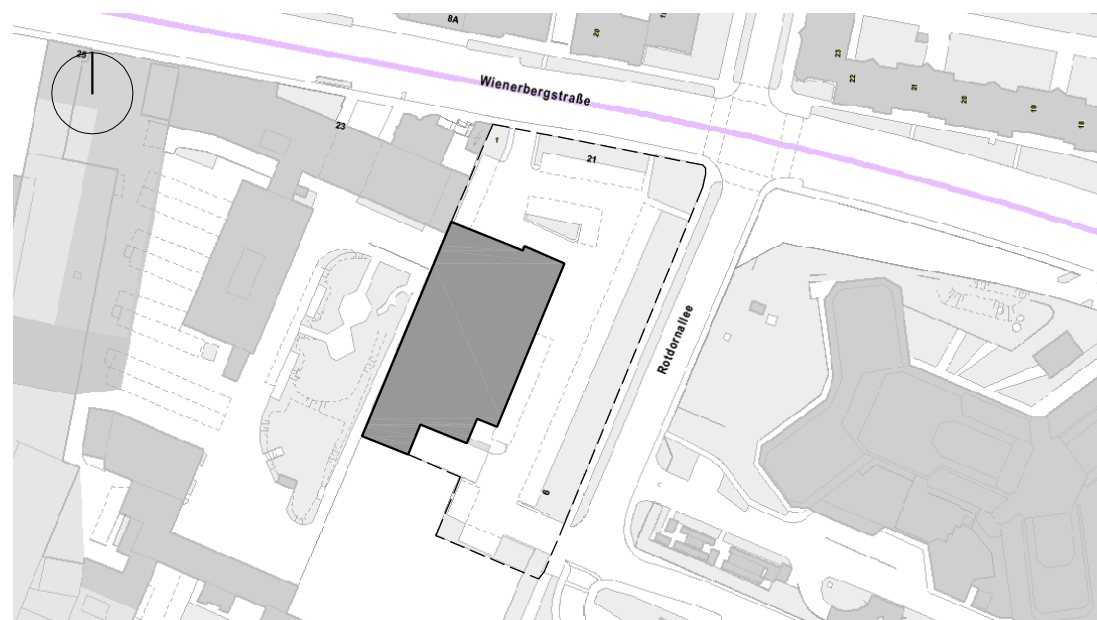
Lageplan Wienerbergstraße M 1:2000⁴⁷
